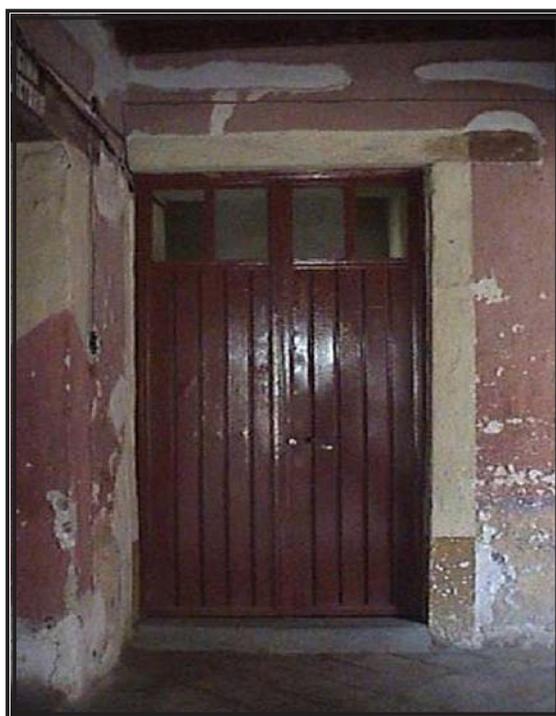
La puerta que comunica la portería con el interior de I claustro ha sido remplazada por una de lámina y el piso de la habitación cubierto con una losa de concreto.
